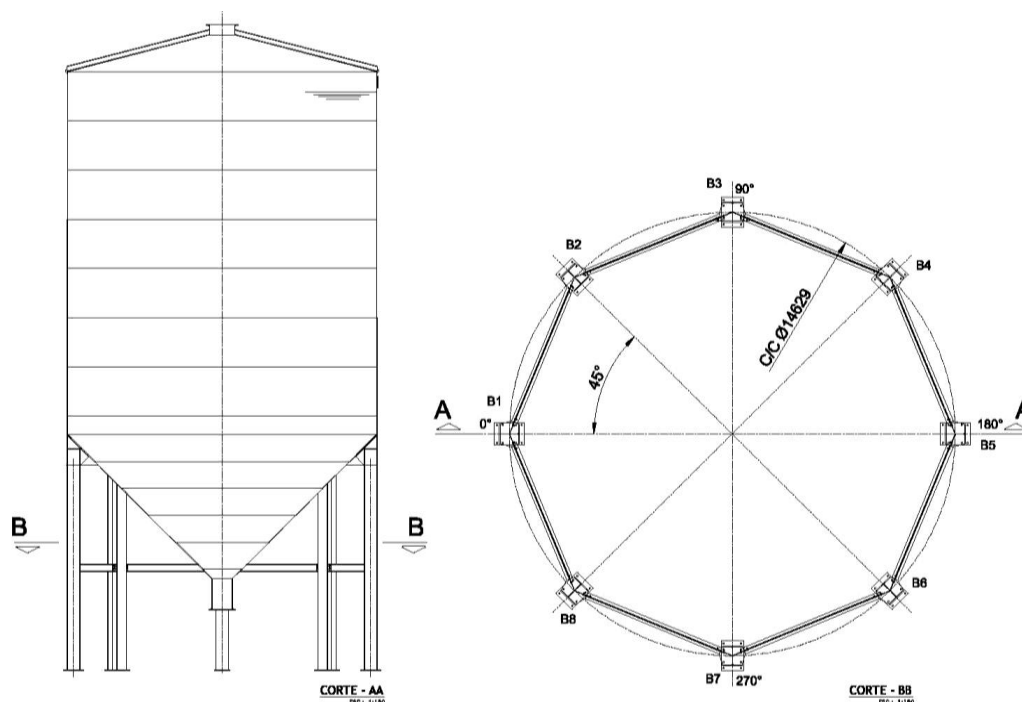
Corte BB – Arranjo das colunas no fermentador.
